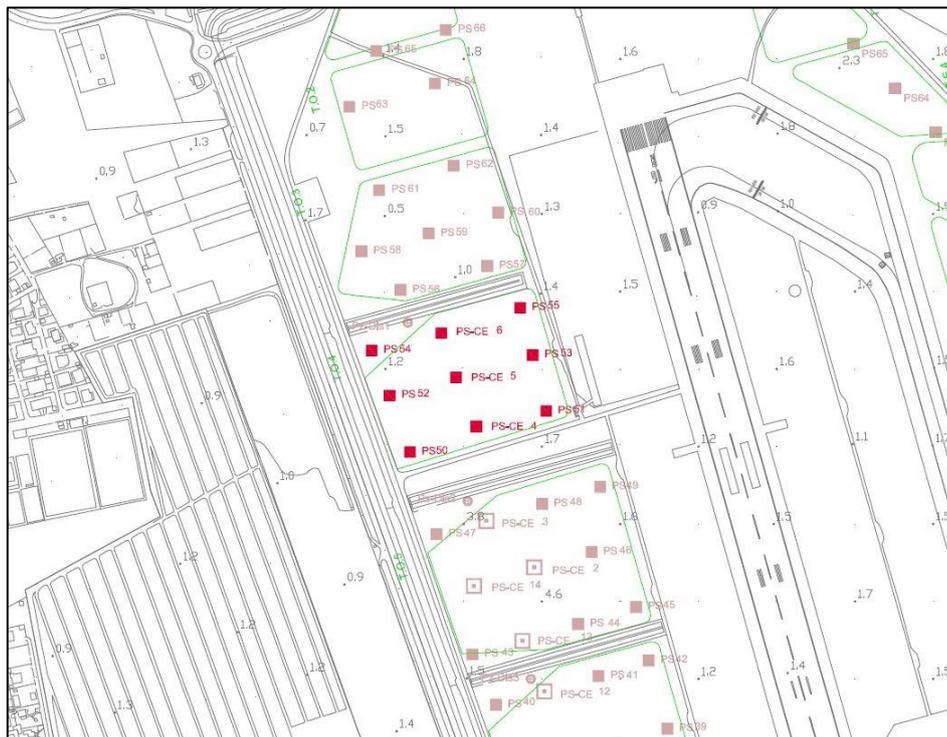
Stralcio planimetrico con l'ubicazione dei punti di indagine nelle aree di riutilizzo per il rimodellamento del terrapieno T.O.4
